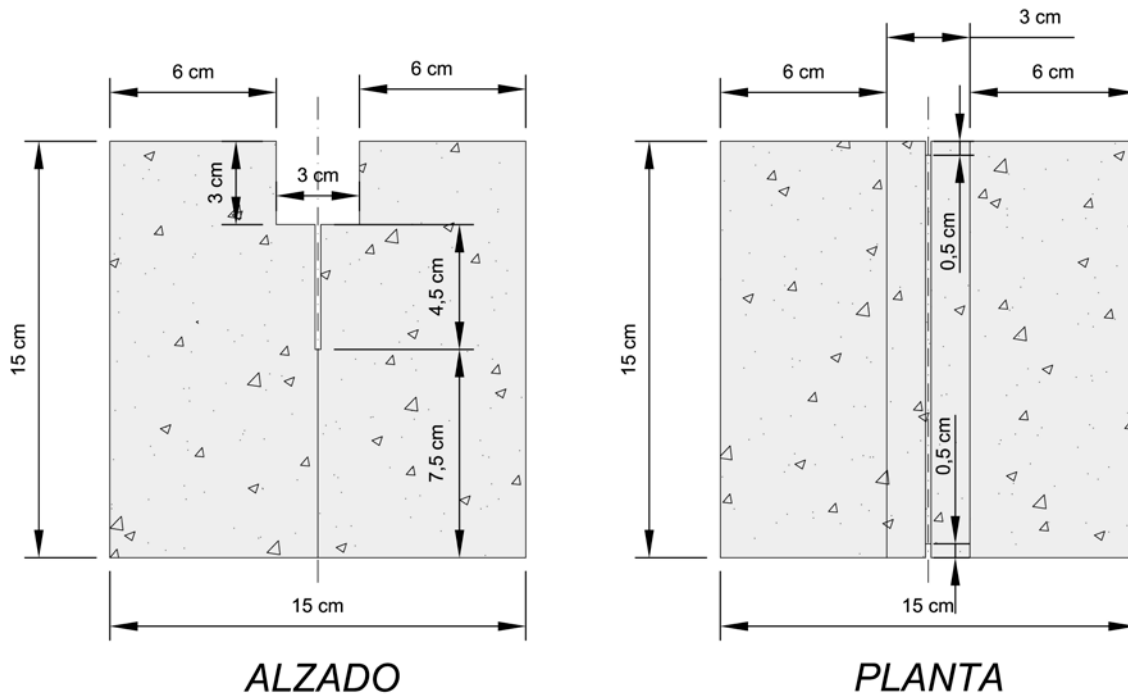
Geometría nominal del espécimen empleado en los ensayos WST (dimensiones en cm).
